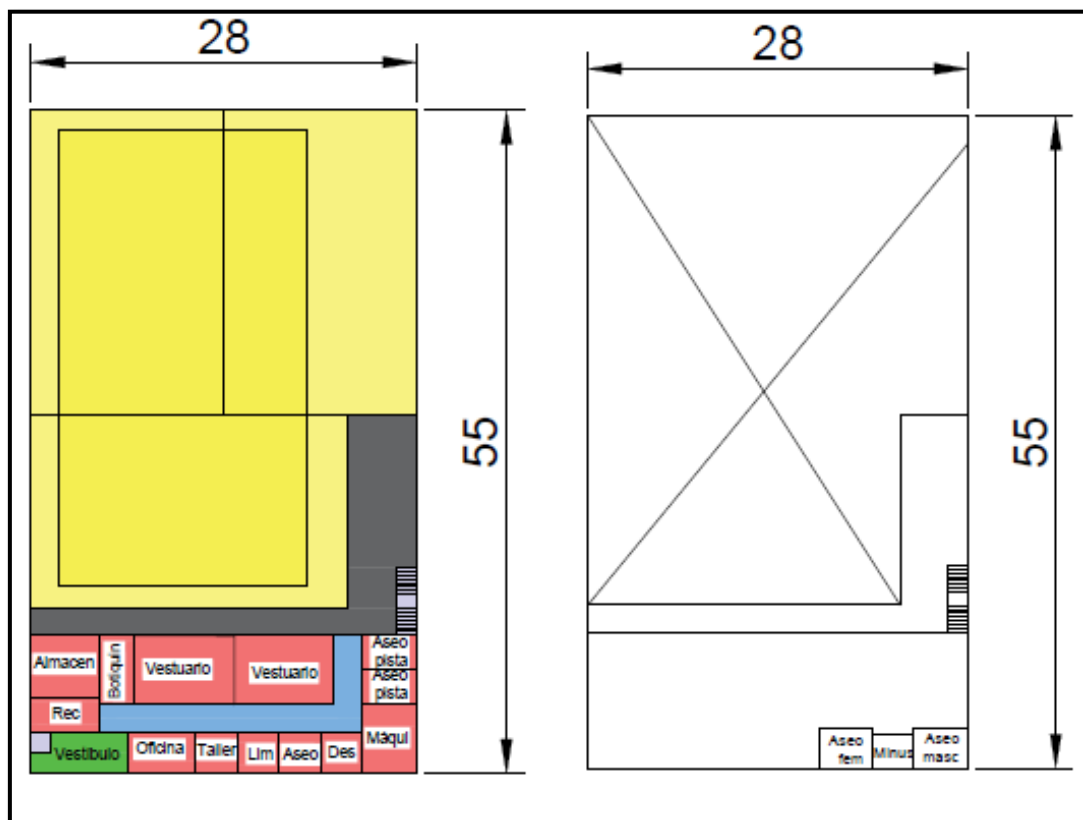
Distribución de los espacios de la alternativa 1. Planta baja (izquierda) y Planta 1 (derecha). (Fuente: Elaboración propia).
